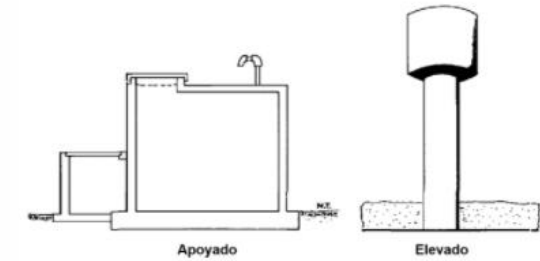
ejemplo tanque elevado y tanque apoyado. Fuente: <https://sswm.info/>
